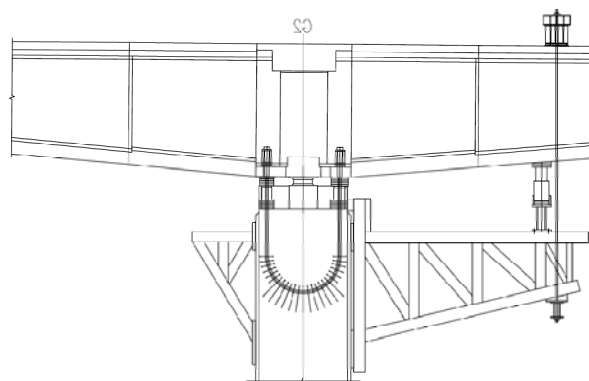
Esquemática de uma consola metálica estabilizadora.
